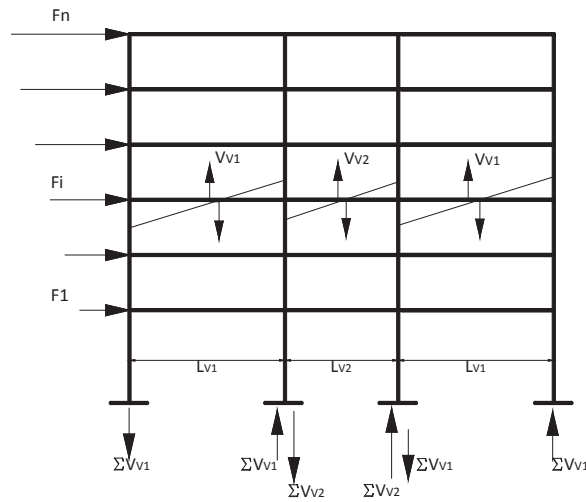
Cortantes de Vigas en Pórtico Irregular
